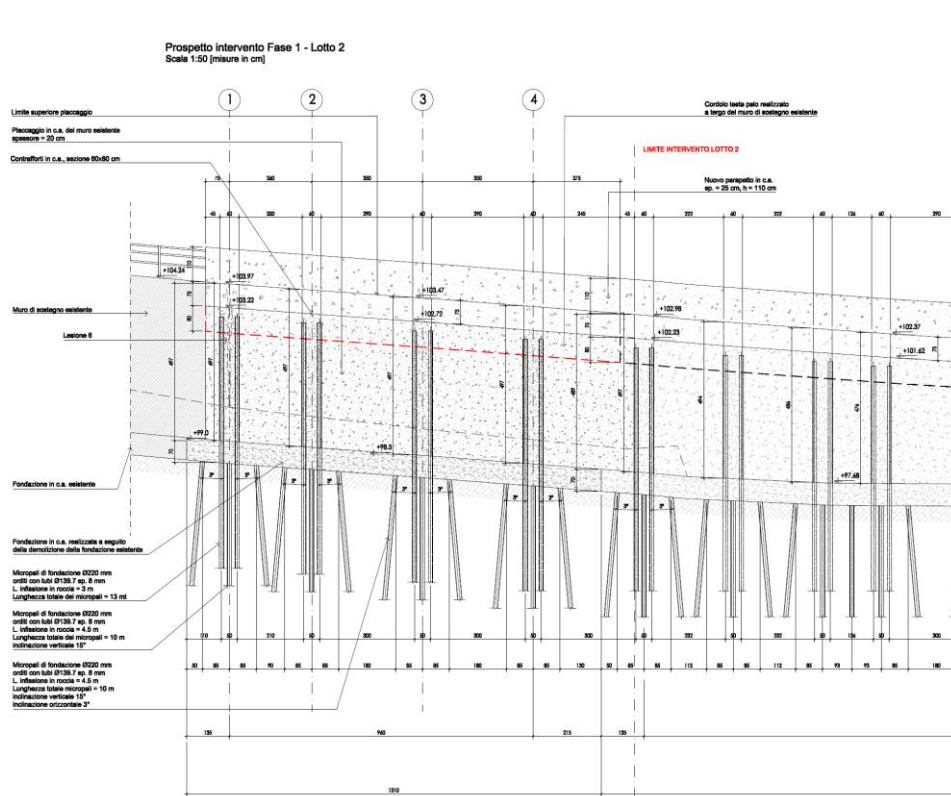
Prospetto intervento Lotto 2 – Fase 1
